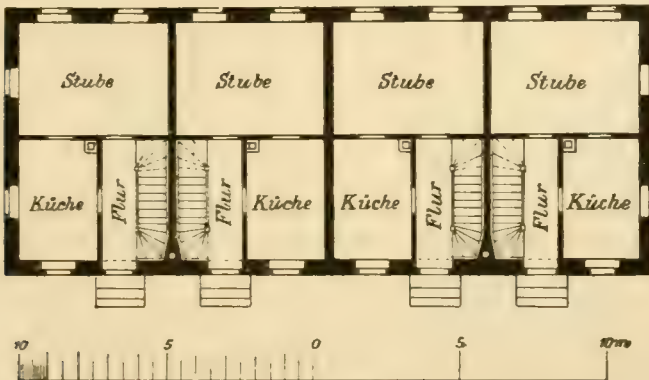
Einfamilienhäuser der Firma Kübler & Niethammer in Kriebstein. Grundrisse der Erdgeschosse.
